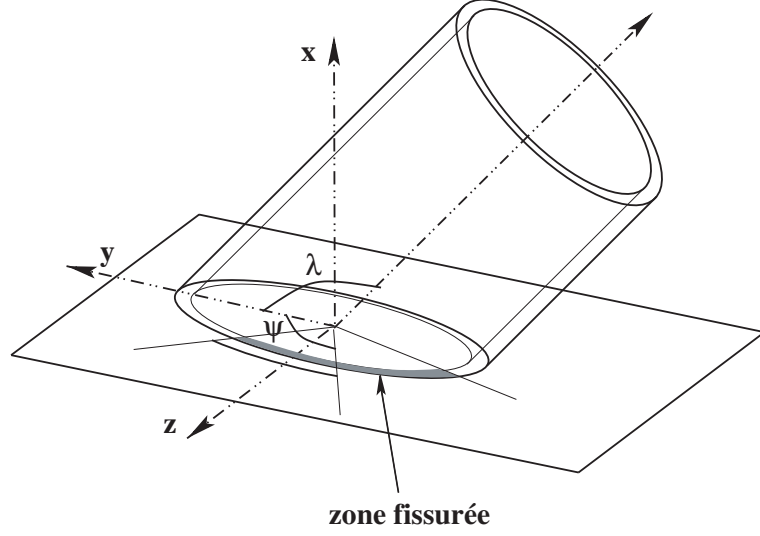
Section fissurée d'un tube incliné (assemblage en Y).
